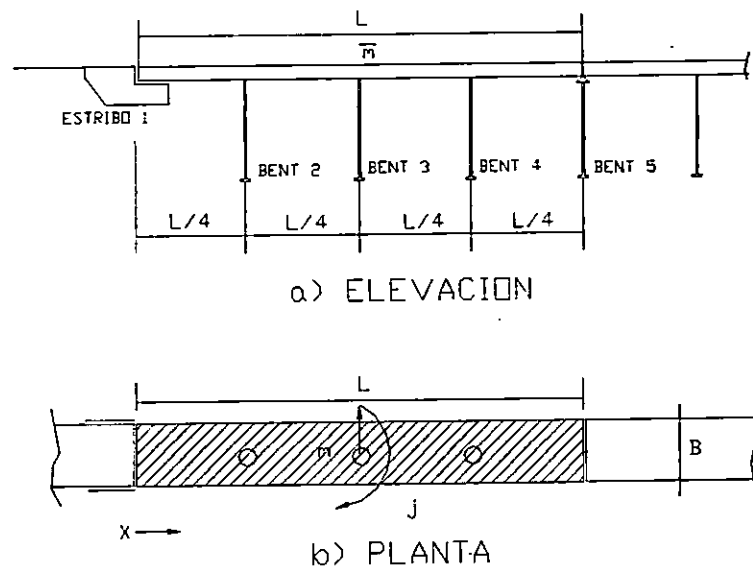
MARCO DE PUENTE CON MULTIPLES PILAS.
